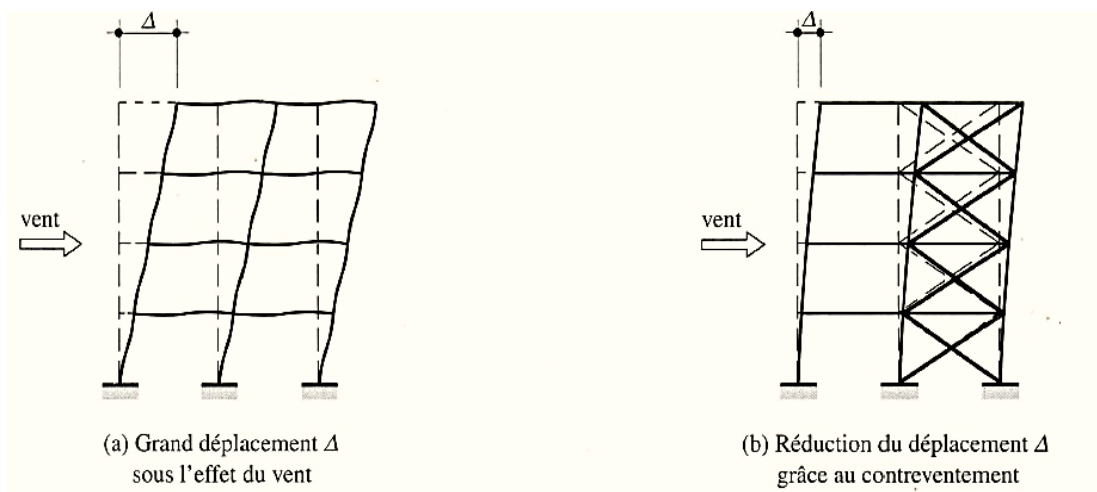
Influence d'un contreventement sur les déplacements horizontaux d'un cadre plan rigide
